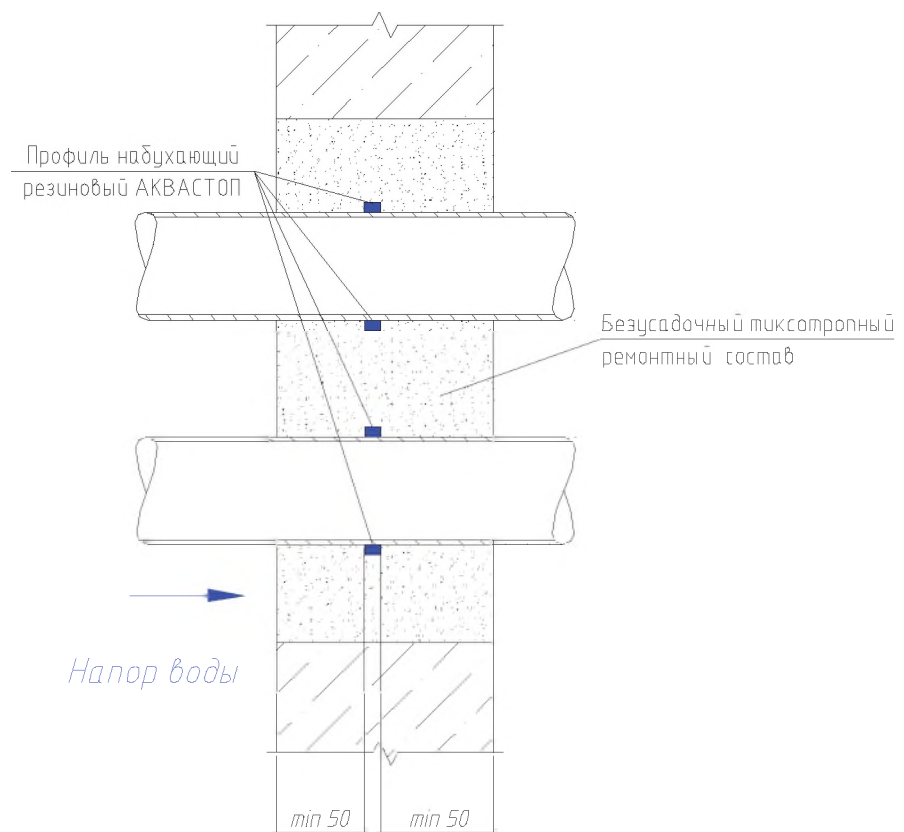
Пересечение нескольких труб со стеной подвала
